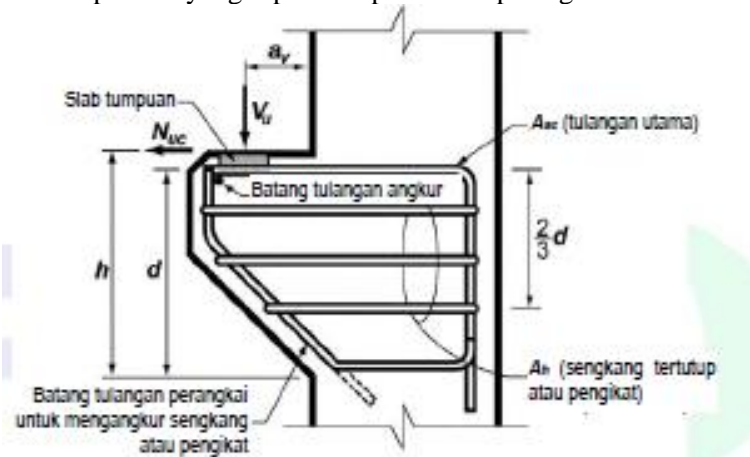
52. Detail Sambungan Kolom-Kolom
